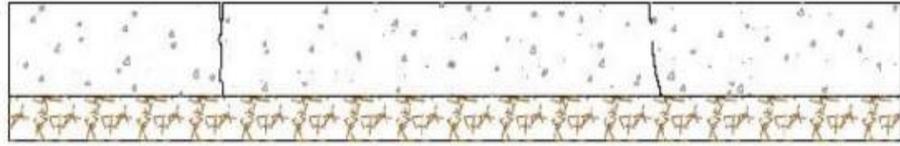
Sección longitudinal de un C C R. Fuente: Sánchez, P. 2014.
